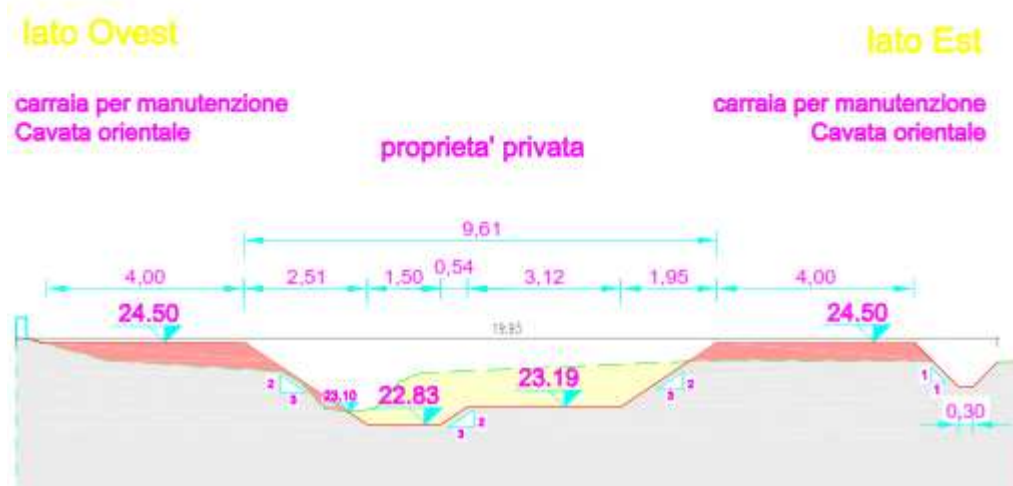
Sezione tipologica di progetto relativa al tratto 1. La linea verde indica la sezione rilevata nello stato attuale, quella rossa la sezione di progetto, mentre l'area gialle indica la sezione di sbancamento e quella rossa la sezione di riporto.
